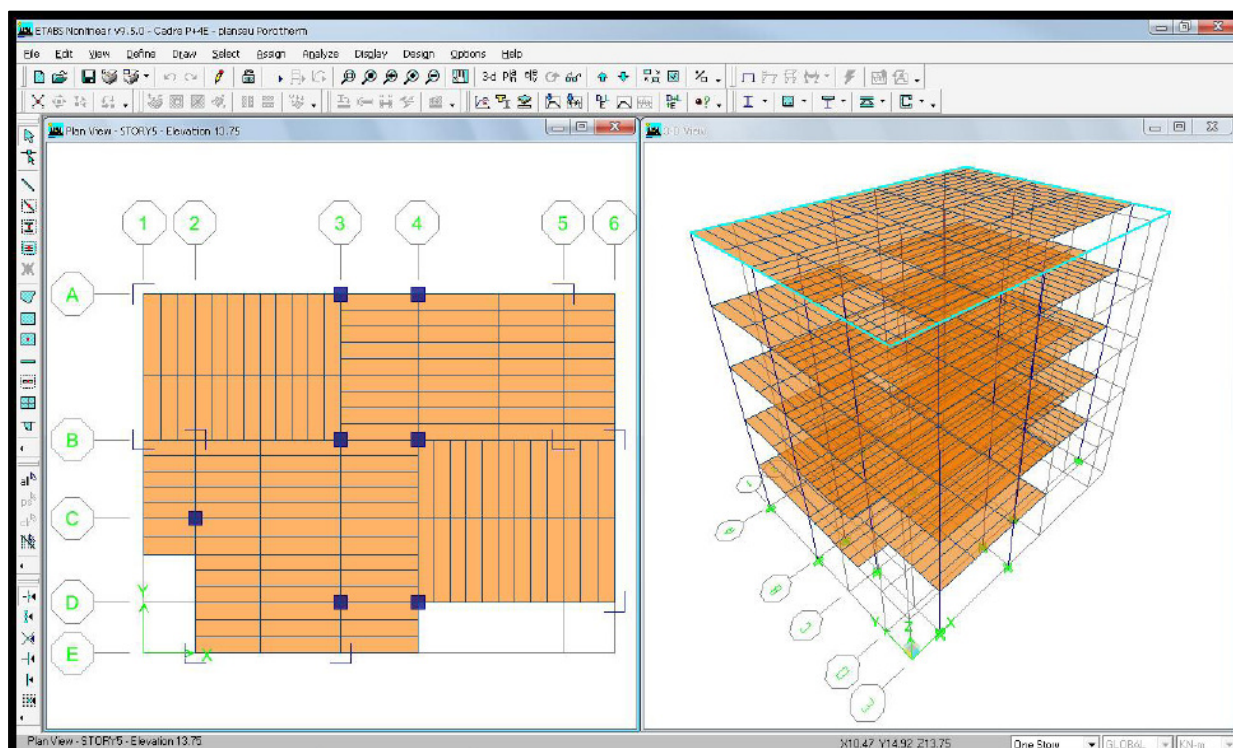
Vizualizare plan si model 3D – structura in cadre de beton armat
